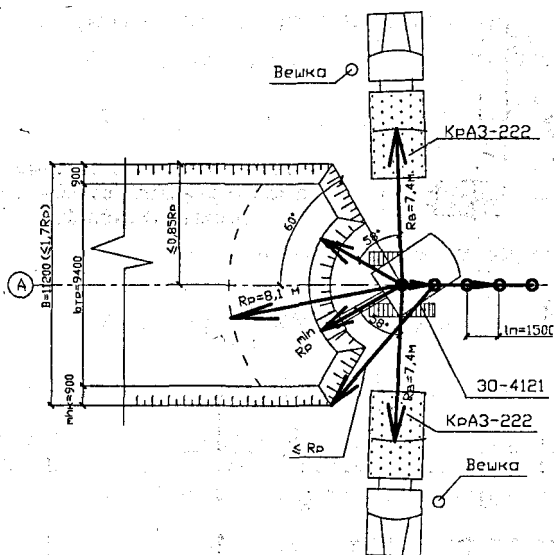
Схема торцевой проходки с движением по прямой экскаваторов "обратная лопата" и "драглайн"
